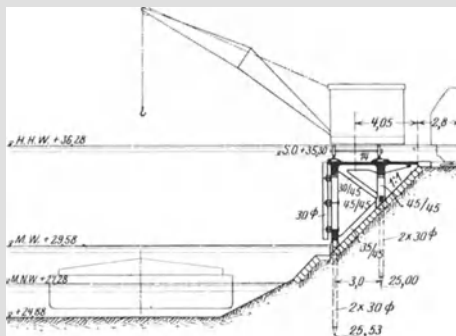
Auf Eisenbetonpfeilern aufgelöste Bauart im Abstand von 4,35.
